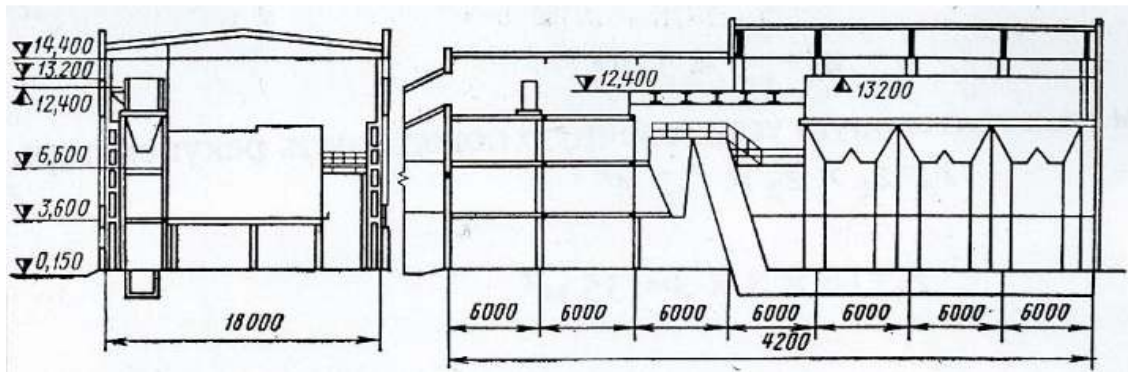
Габариты и схема здания котельной установки на 35 МВт (30 Гкал/ч) с котлоагрегатами, сжигающими твердое топливо в слое (проект Латгипропрома).
